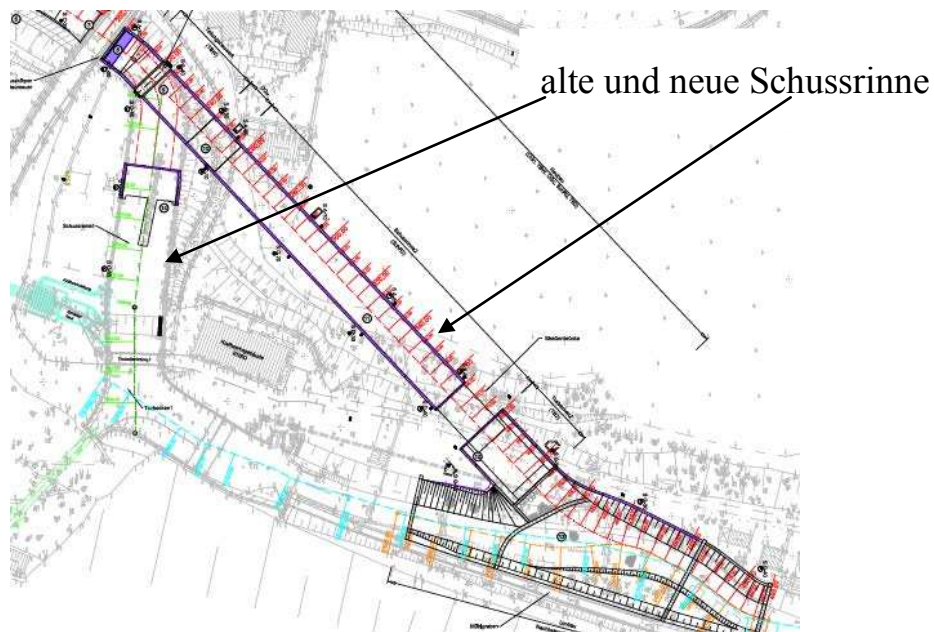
Lageplan Vorzugsvariante, Ausschnitt Teilungsbauwerk
